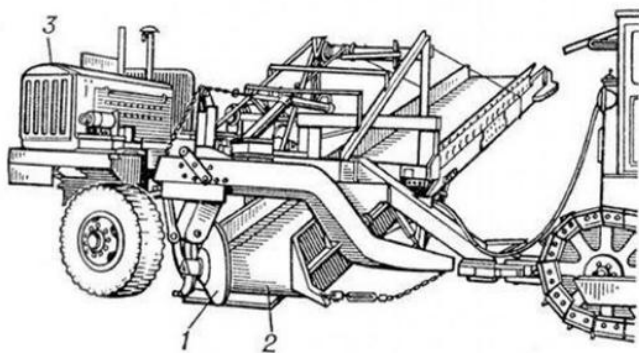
Общий вид прицепного грейдер-элеватора: 1-рабочий орган- нож в форме диска; 2- ленточный транспортёр; 3- двигатель
